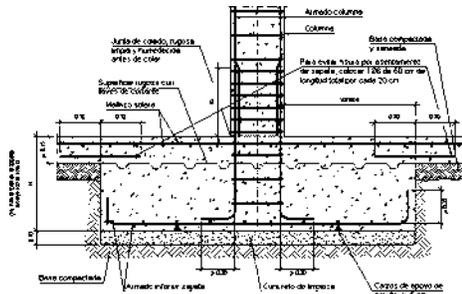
/alzado de zapata aislada/foto obtenida de sist. Constructivos pdf
